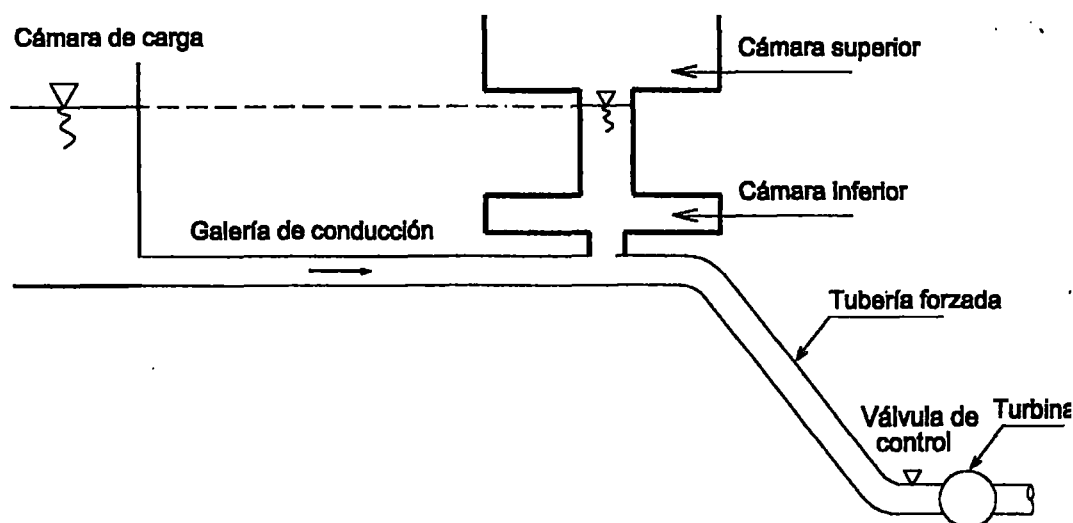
Sistema compuesto de túnel y tubería a presión con chimenea de equilibrio.
